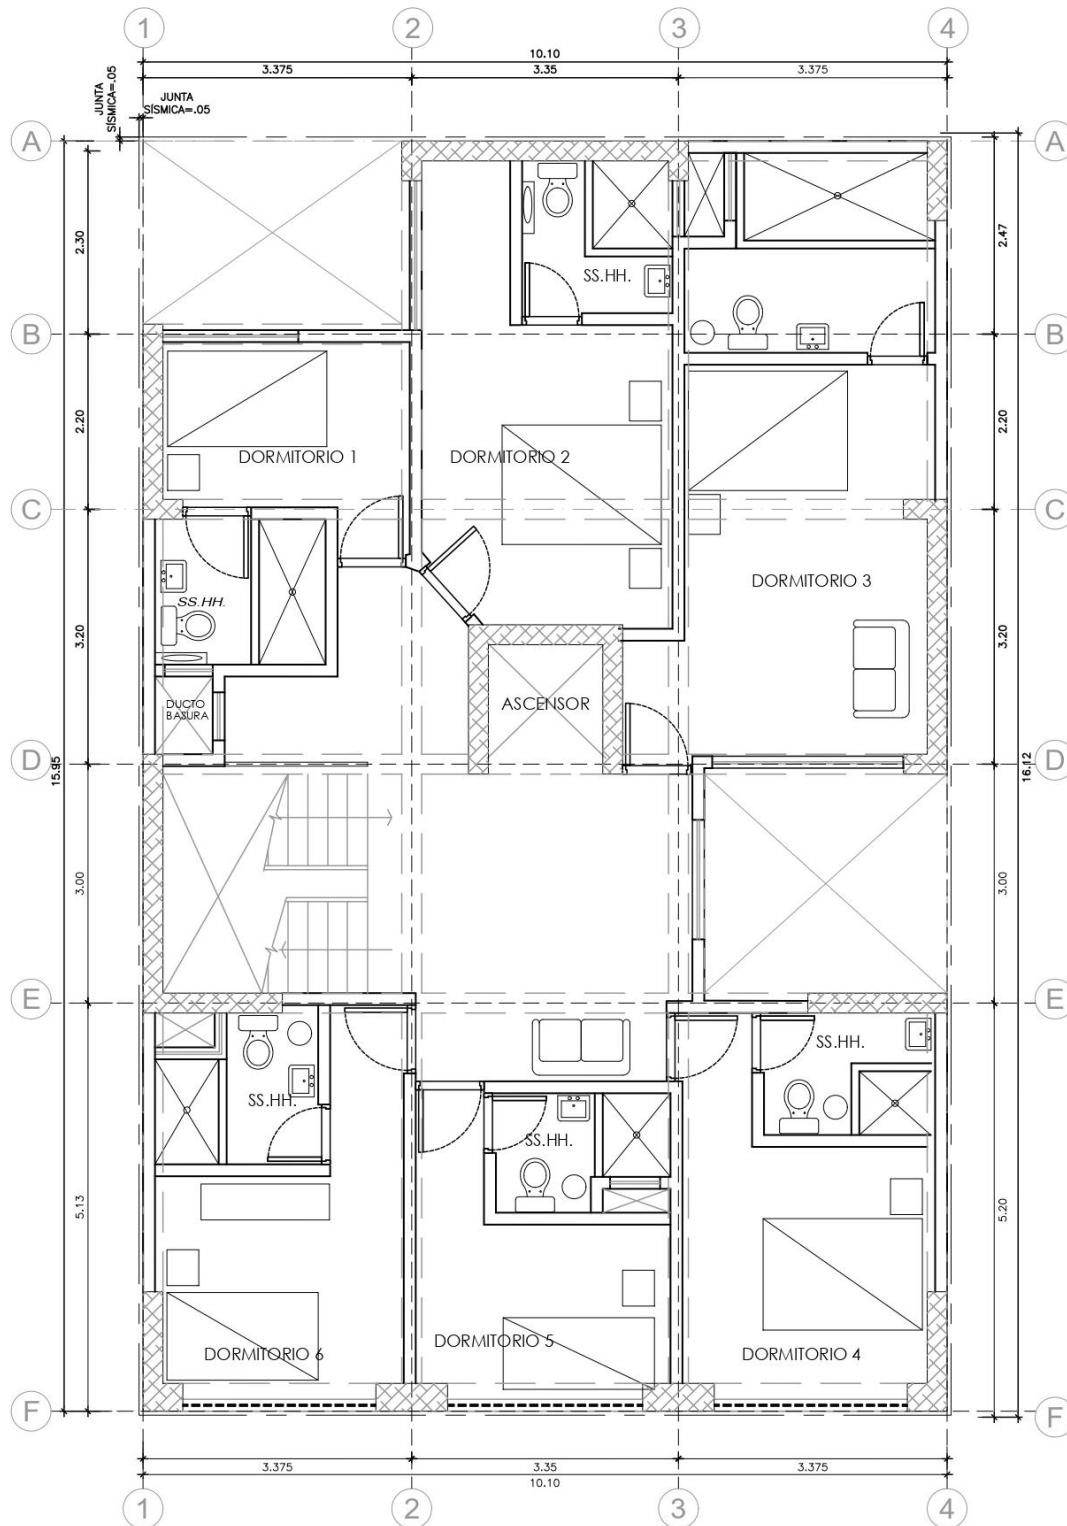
Planta arquitectónica de piso típico. Fuente: Propia.
